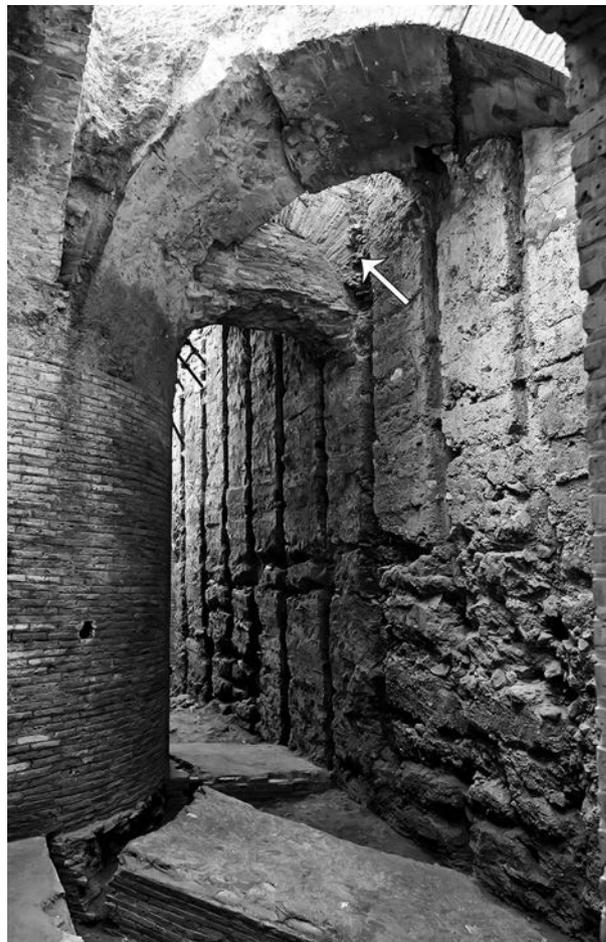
Après avoir pris appui sur le pilier, la fondation du mur n° 92 repose pour partie sur l'arc n° 9 mais elle débordé par rapport à celui-ci; les constructeurs ont, de ce fait, introduit un petit arc entre le pilier et la fondation n° 70 de la phase 2 (cliché Ch. Durand).
